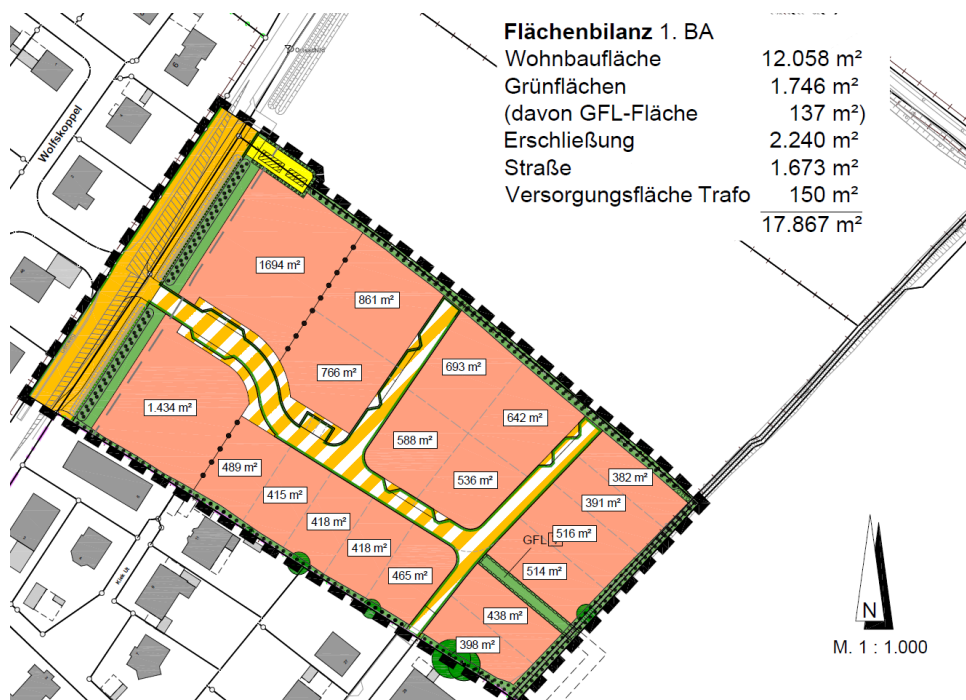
Ausschnitt Flächenbilanz B-Plan Vorentwurf
